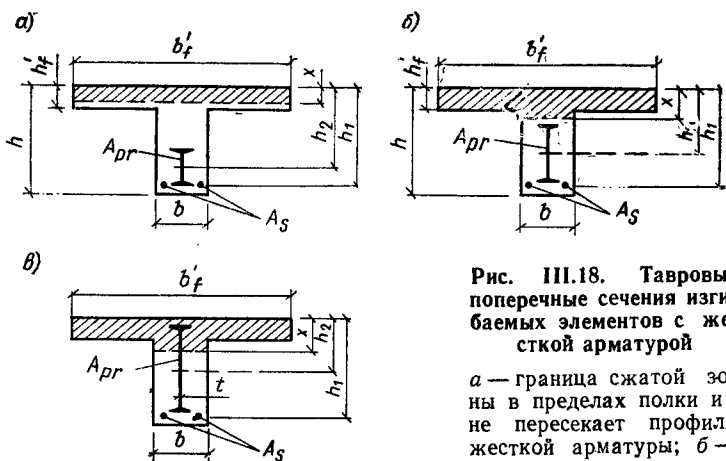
Тавровые поперечные сечения изгибаемых элементов с жесткой арматурой
